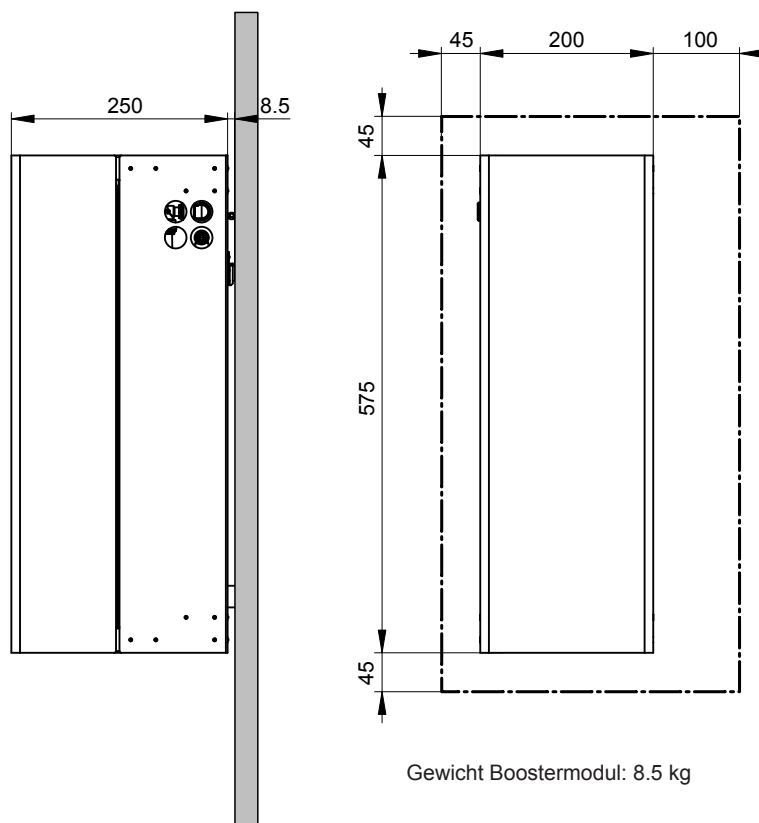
Abmessungen Boostermodul (Masse in mm)
